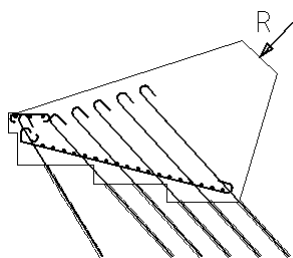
Schéma tvaru opěry založené na půdě, kde je základová půda hluboko pod patkami oblouku
